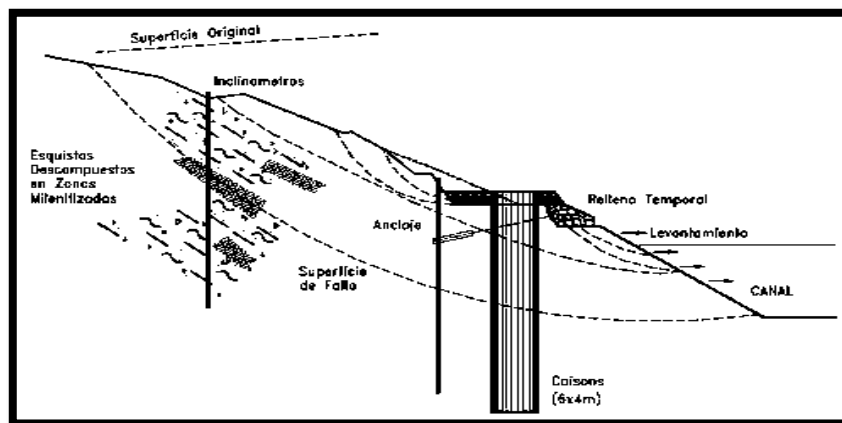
Utilización de pilas o caissons para estabilizar un deslizamiento (Brandl, 1996).
